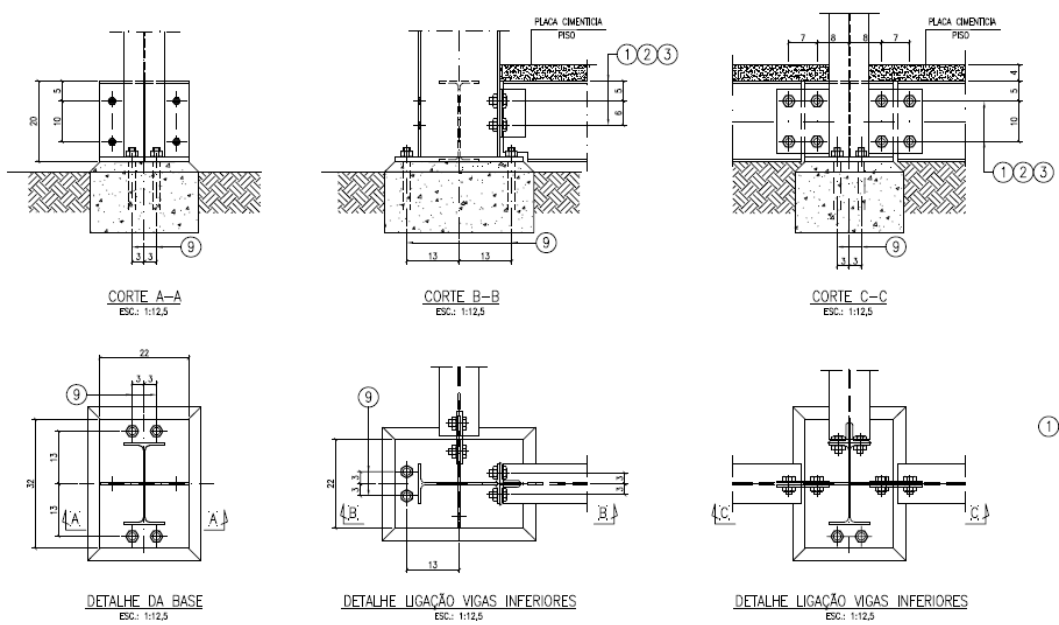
Detalhes do Projeto Executivo Vigas Inferiores-
